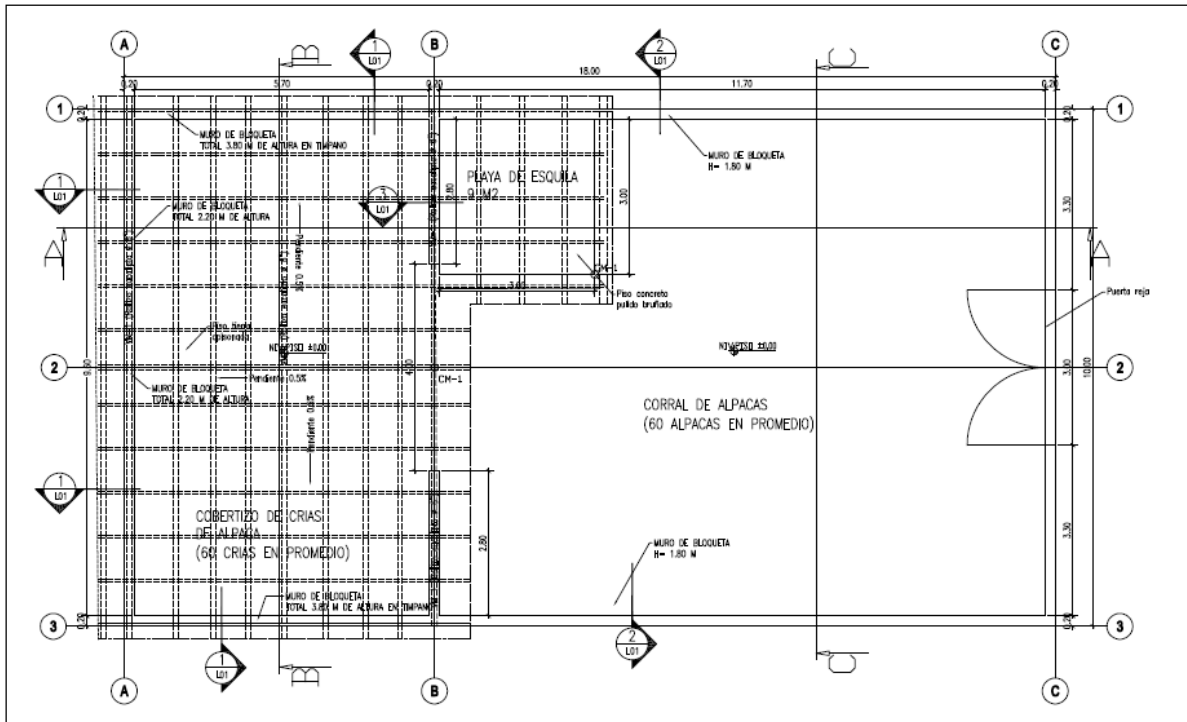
Plano en Planta Cobertizo diseño 02. Macusani, Puno
